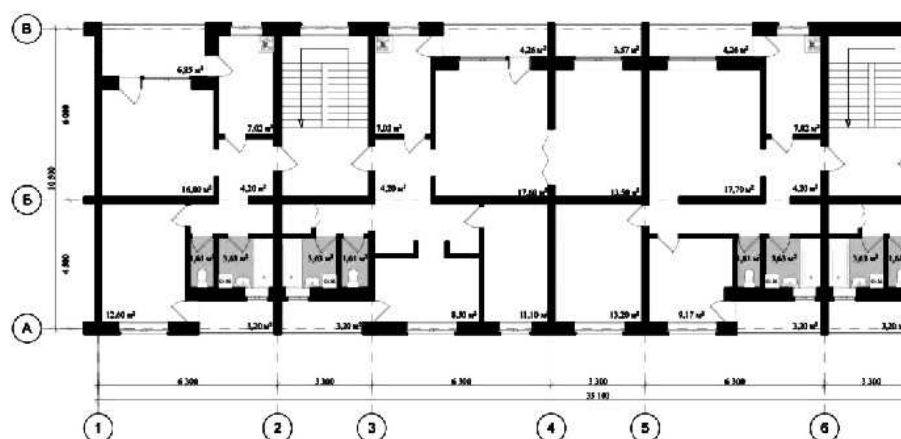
План пятиэтажной блок - секции жилого дома (секция 2-4-3-3) серии 135
